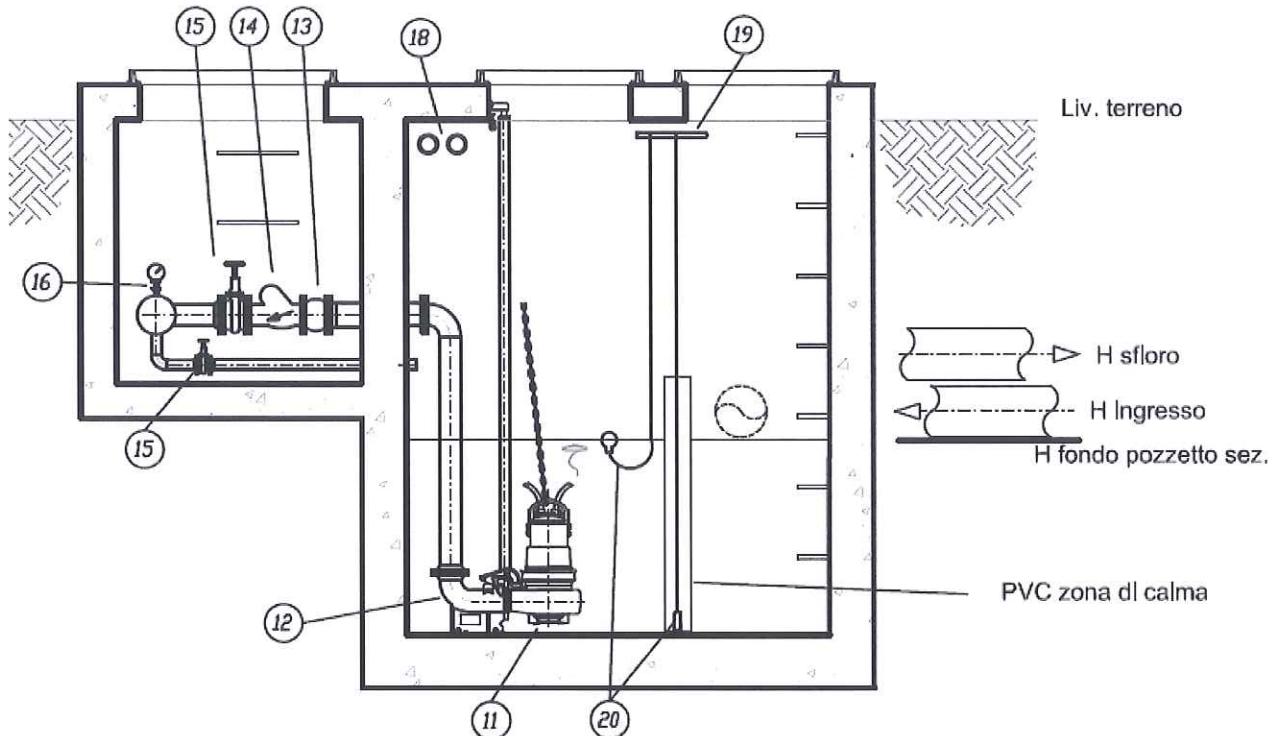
planimetria impianto di sollevamento fognario, schema tipo.
